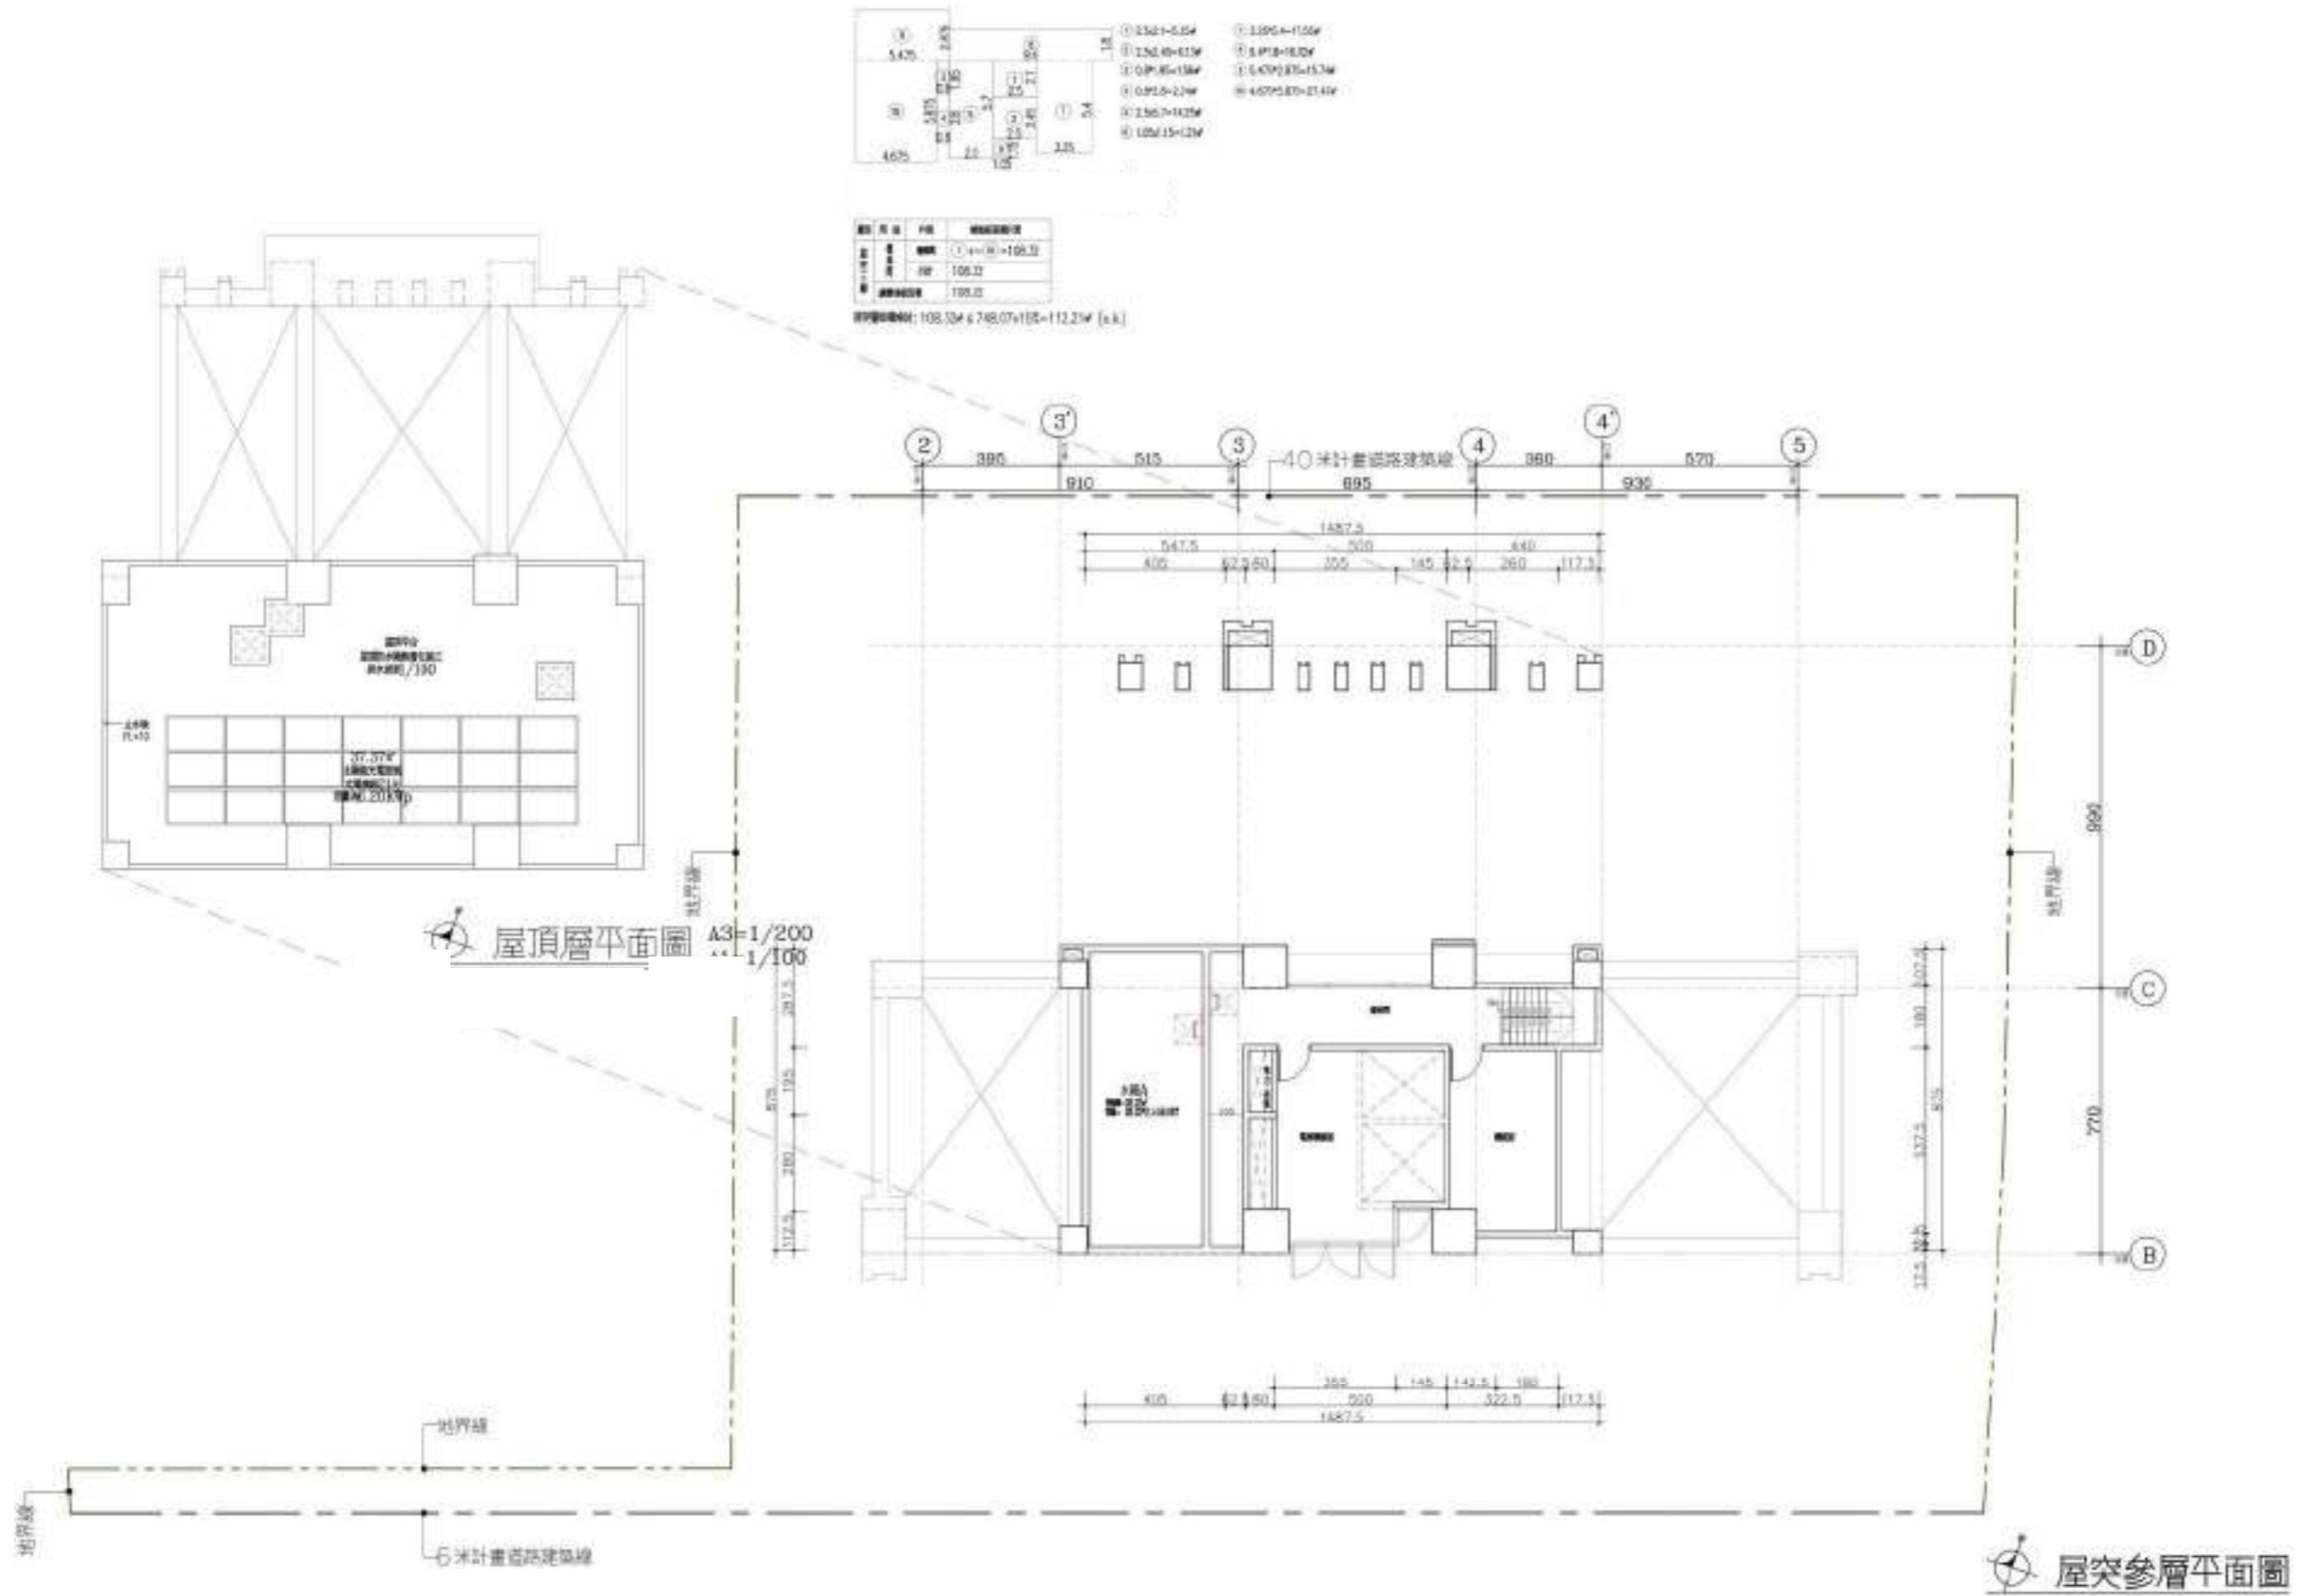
屋突三層平面圖 (比例尺 1/200)
